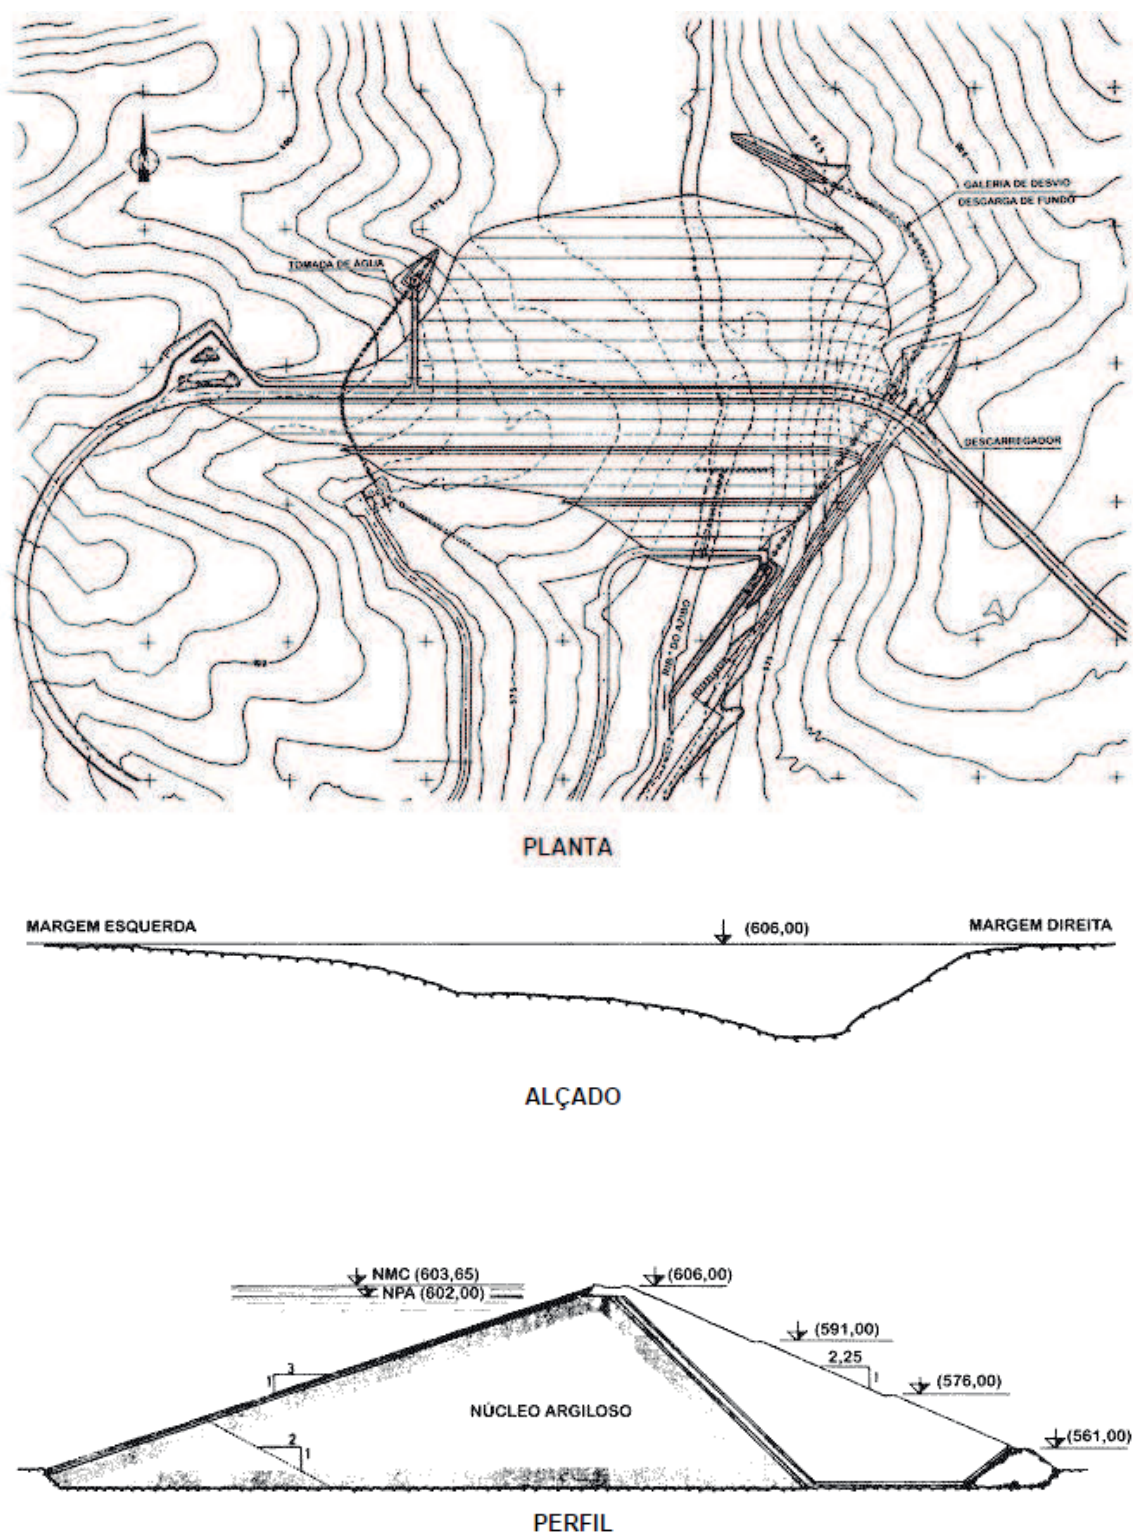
Projeto Barragem do Azibo (Planta, alçado e perfil), (<http://sir.dgadr.pt>).
